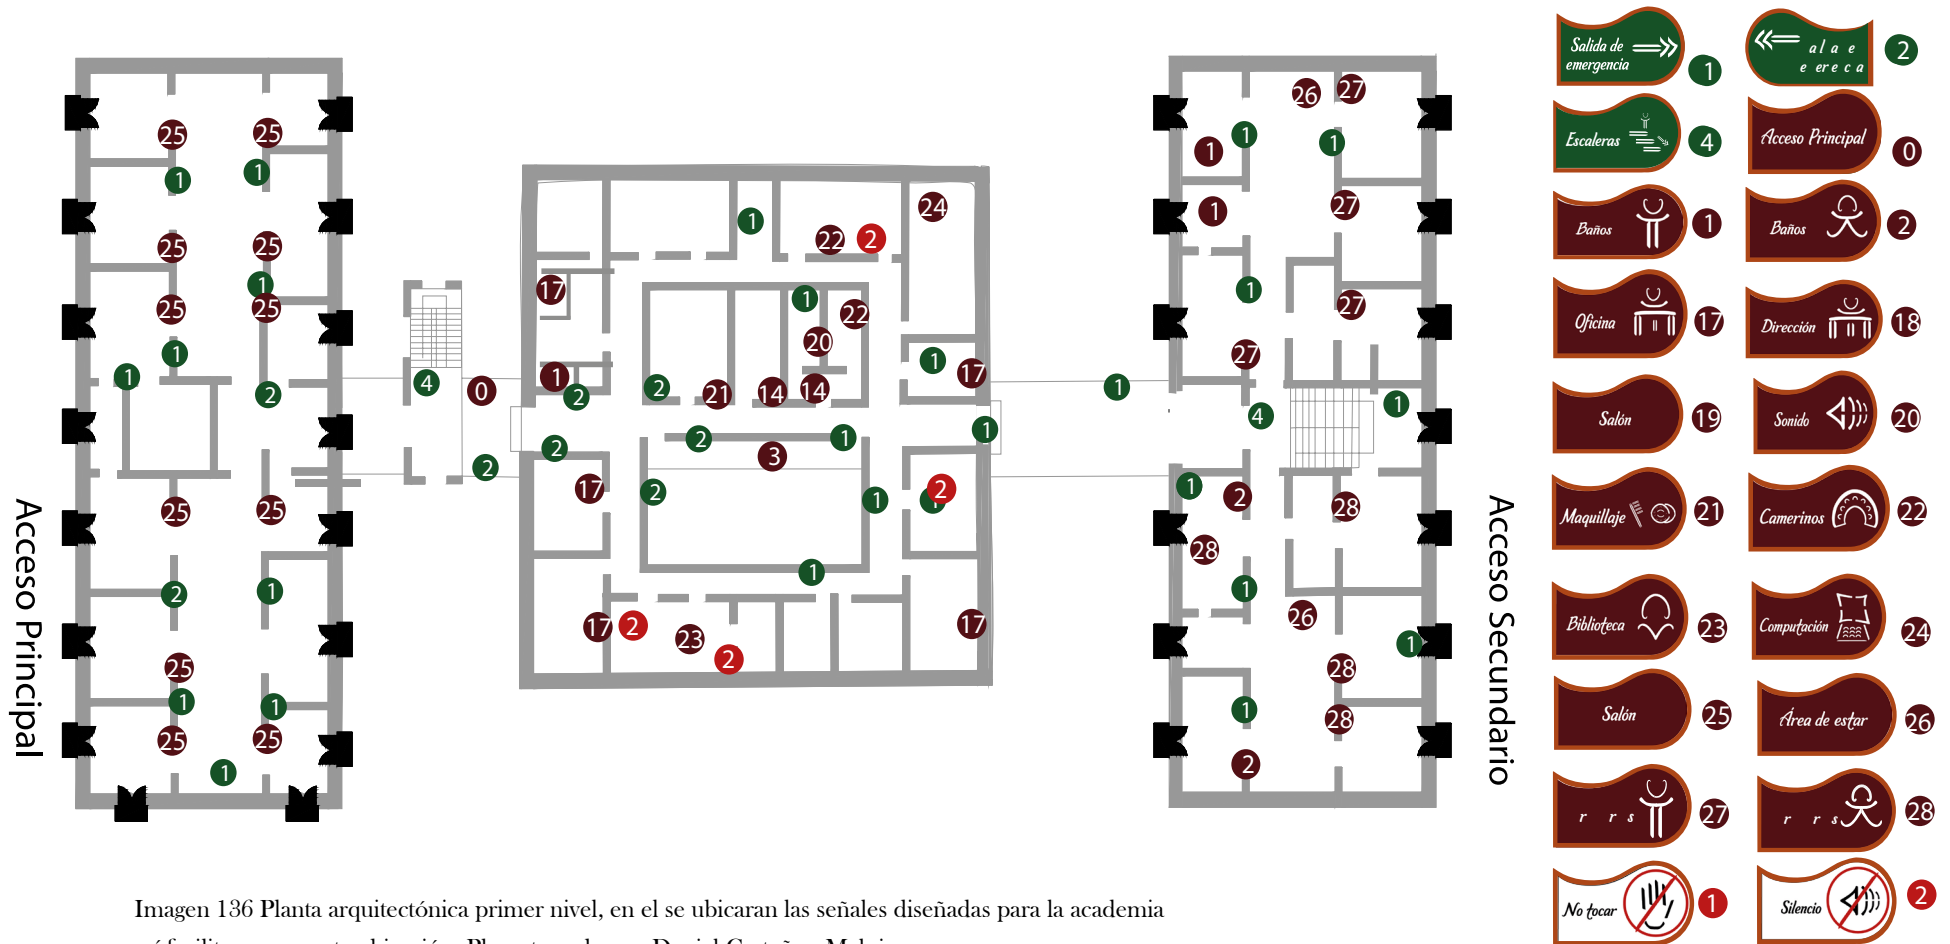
Planta arquitectónica primer nivel, en el se ubicaran las señales diseñadas para la academia así facilitara su pronta ubicación. Plano trazado por Daniel Castañon.Malpica
